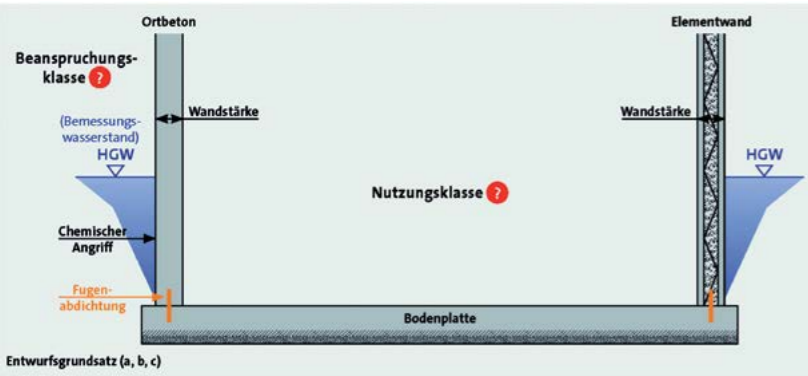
Beanspruchungs- und Nutzungsklassen bei WU-Betonen
